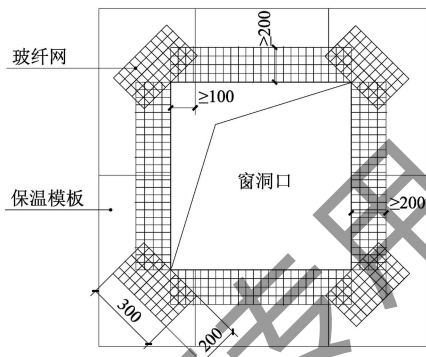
窗洞口部位玻纤网增强示意图
